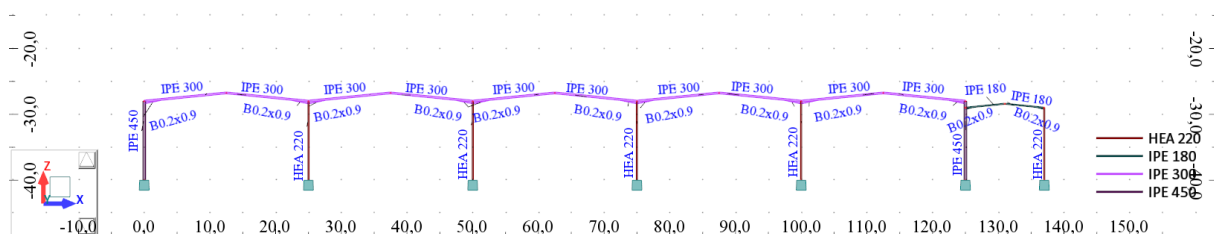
E1 - S2 – pórtico com pilares encastrados
